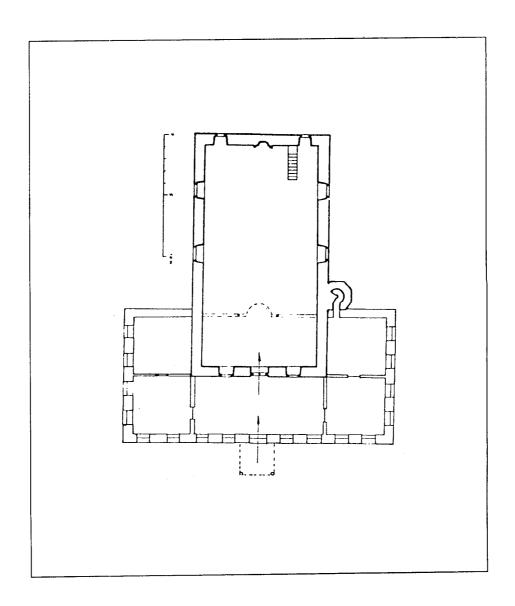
مسقط أفقي لمسجد حسام الدين في اشتب (عن : كيل) .
